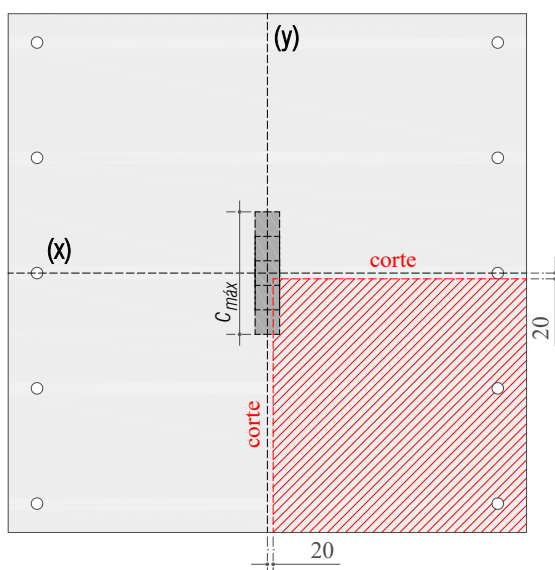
Plano de corte das lajes em destaque hachurado (mm)
